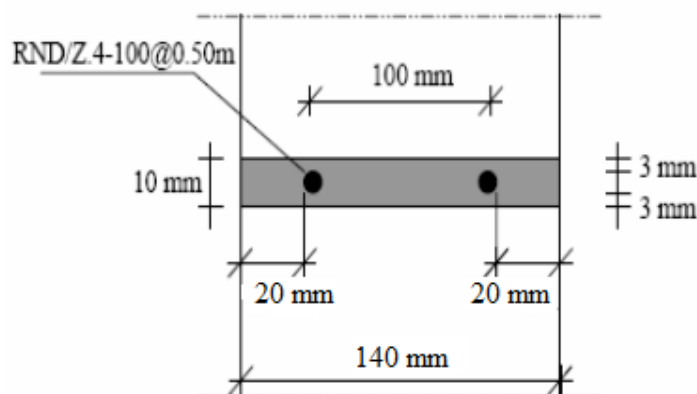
Detalhes da junta de assentamento (seção transversal) para bloco cerâmico com espessura igual 14 cm (adaptada de LOURENÇO, 2008).
